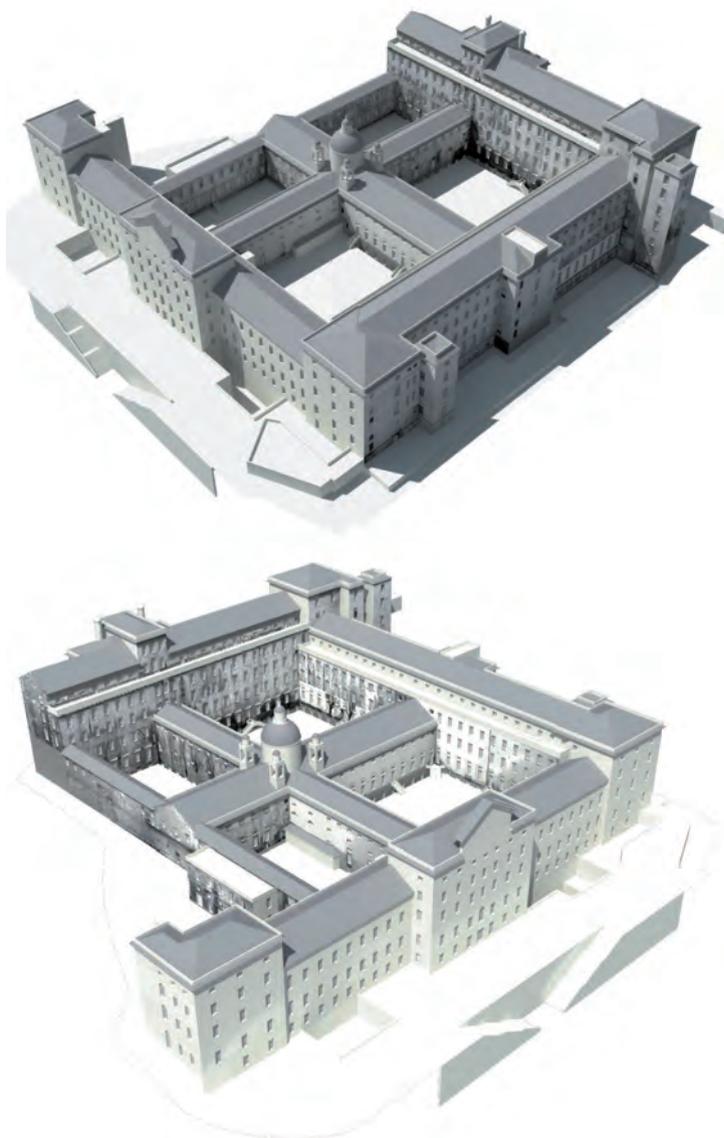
Modello tridimensionale del complesso architettonico con inserimento dei fotopiani delle facciate: viste sud-est e sud-ovest
